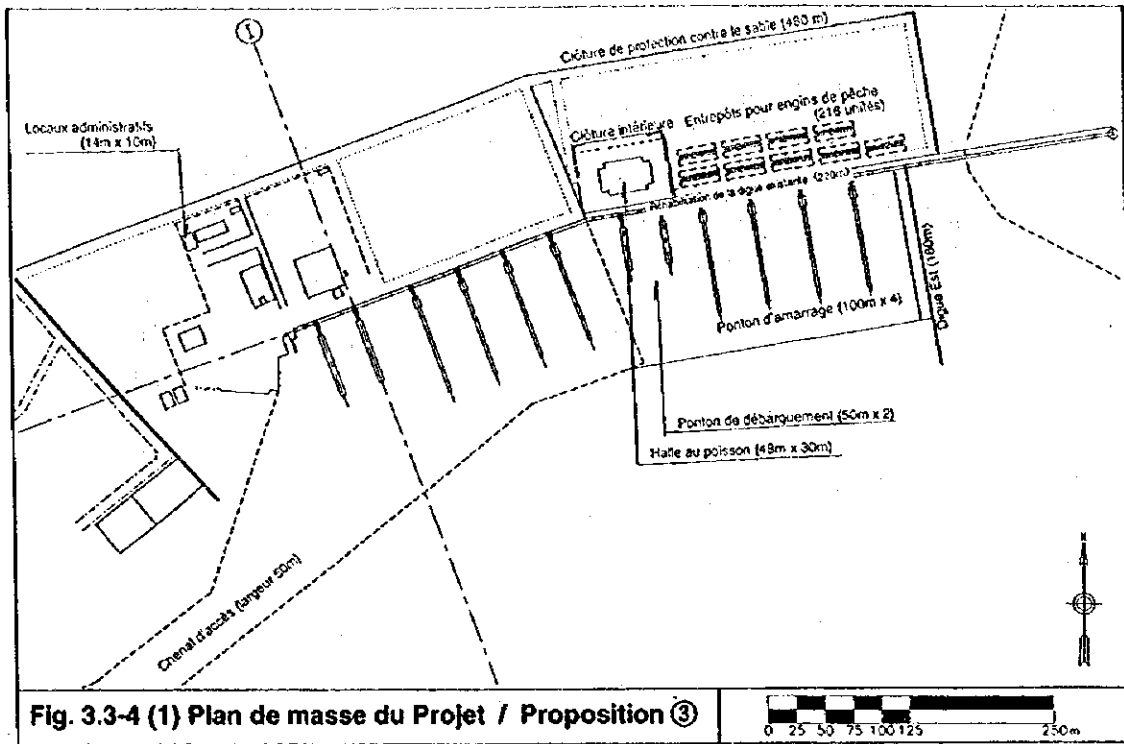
(1) Plan de masse du Projet / Proposition ③
